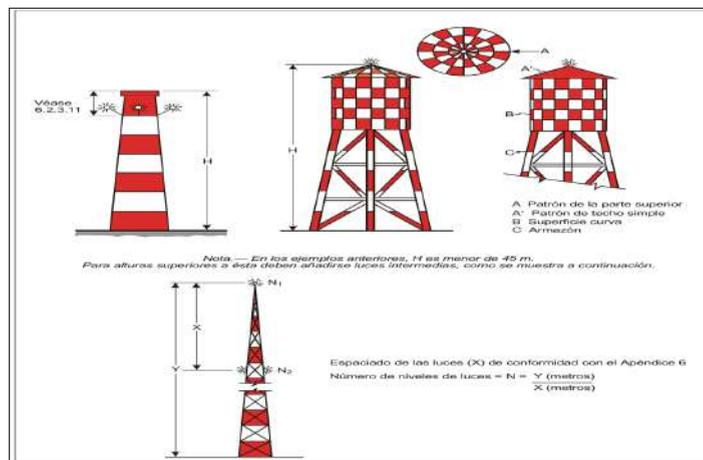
Ejemplos de señalamiento e iluminación de obstáculos en el caso de estructuras elevadas
